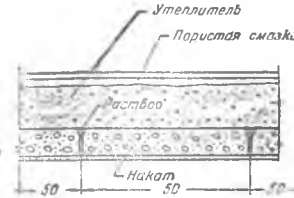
Перекрытия с несущим накатом и выступающими деревянными балками
